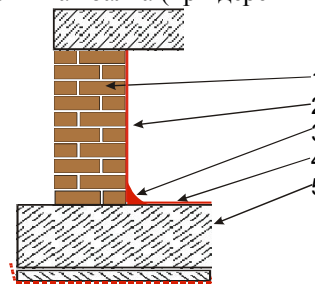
Гидроизоляция существующей стены или дымового канала при напоре грунтовой воды или влажности без отложений на поверхности соли:
